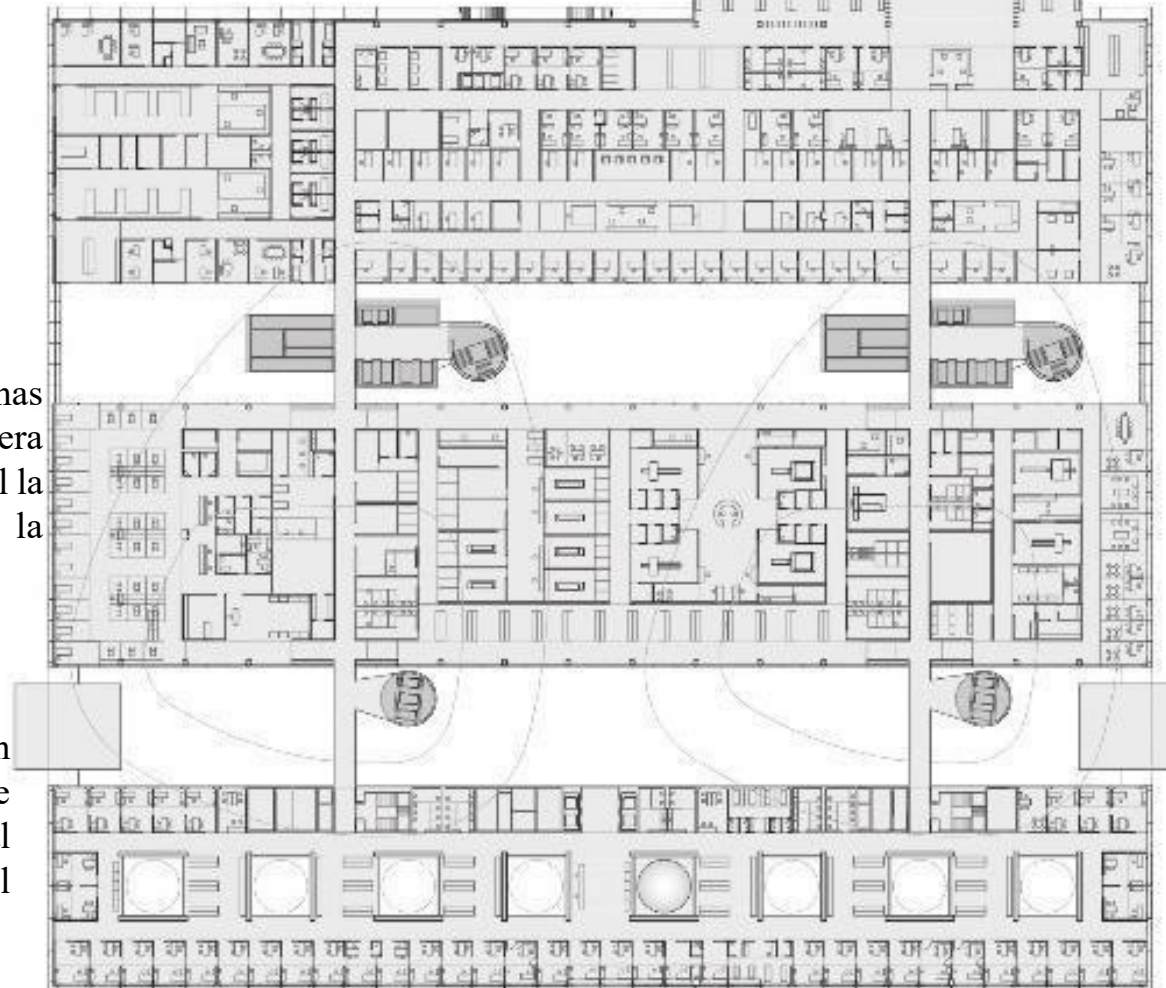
Planta Primer Piso Hospital Rey Juan Carlos
